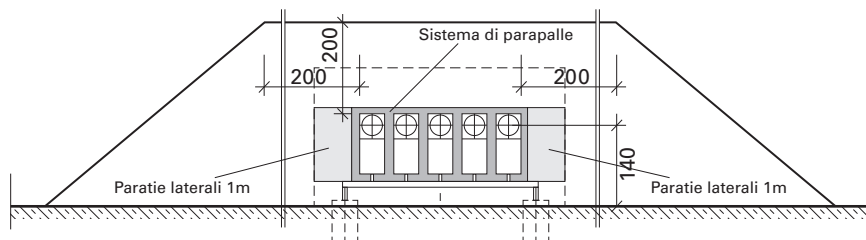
Stand per il tiro alla pistola a 25 m con parapalle naturale (terrapieno)
